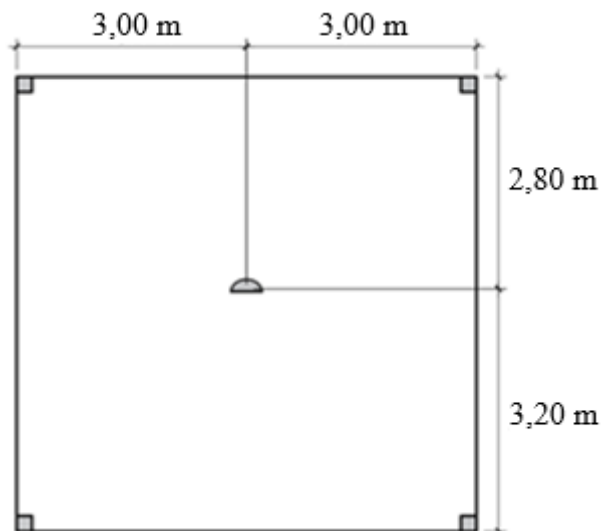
Laje lisa com pilar central de seção semi-elíptica.
